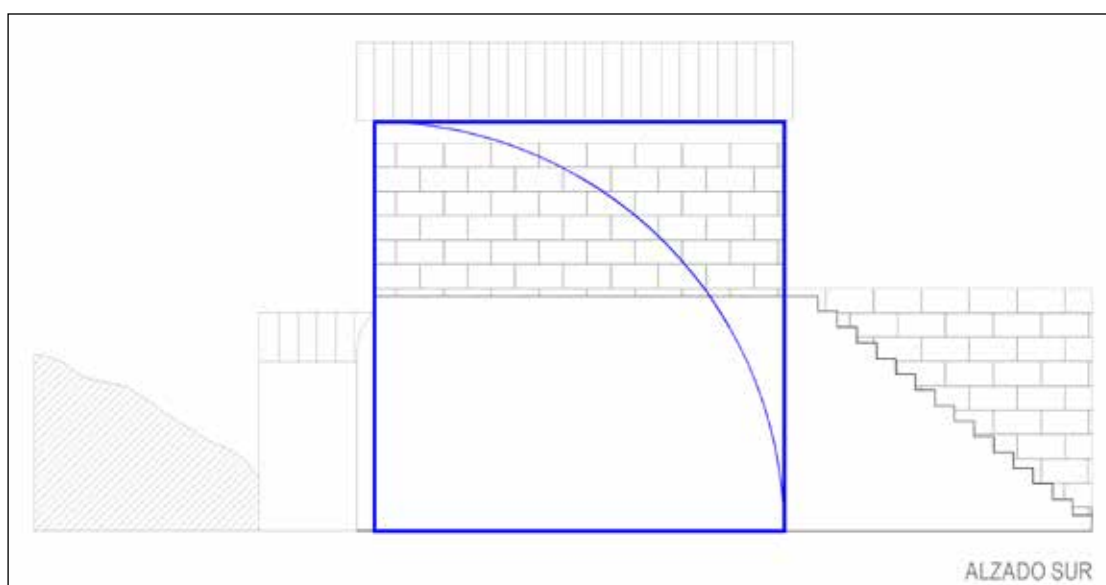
Alzado del muro longitudinal del aula. Fuente: Elaboración propia.
